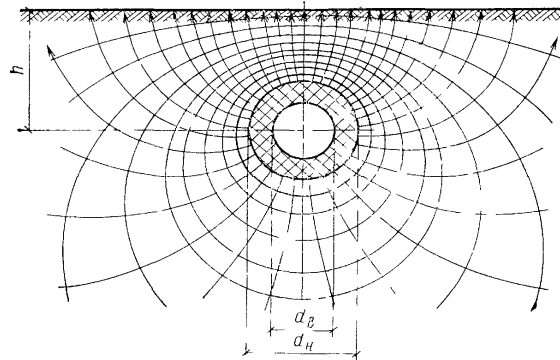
Поперечный разрез теплопровода , проложенного бесканально в грунте
